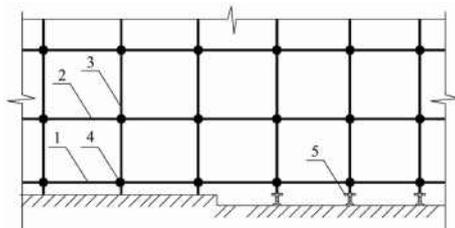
基础顶面高差较小时扫地杆构造
